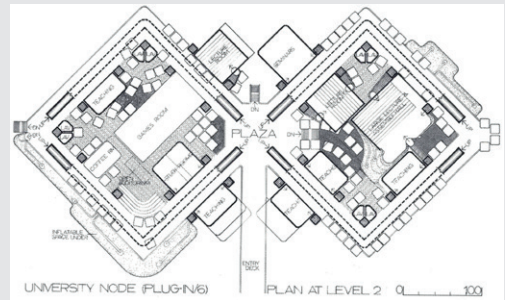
Equipamiento en un nodo de la estructura. Planta de edificio universitario.
